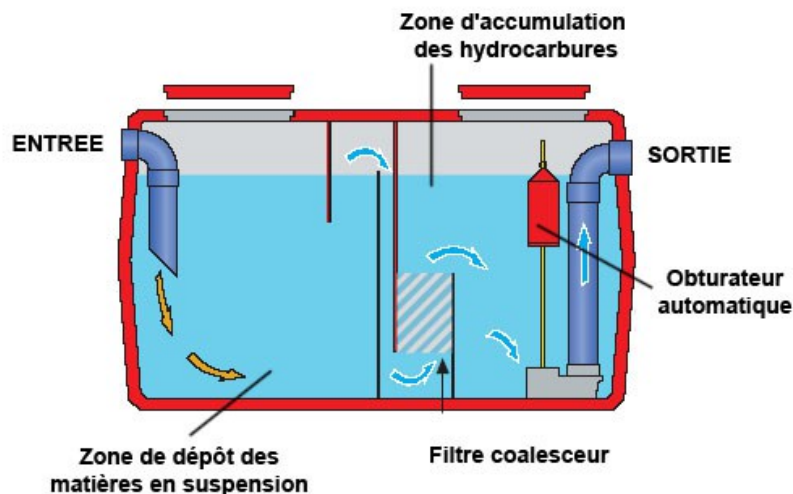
Vue en coupe d'un séparateur à hydrocarbures
